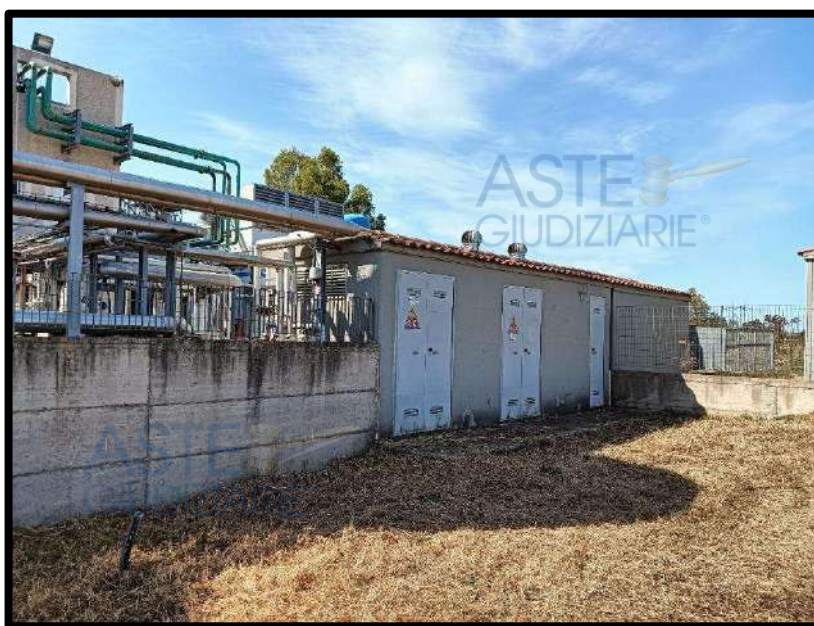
Vista generale cabine elettriche (esterno lotto)
